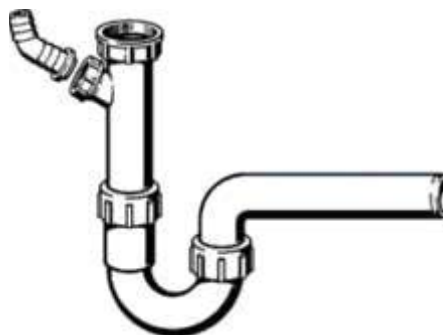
Geruchverschluss für Küchenspüle mit Spülmaschinenanschluss
